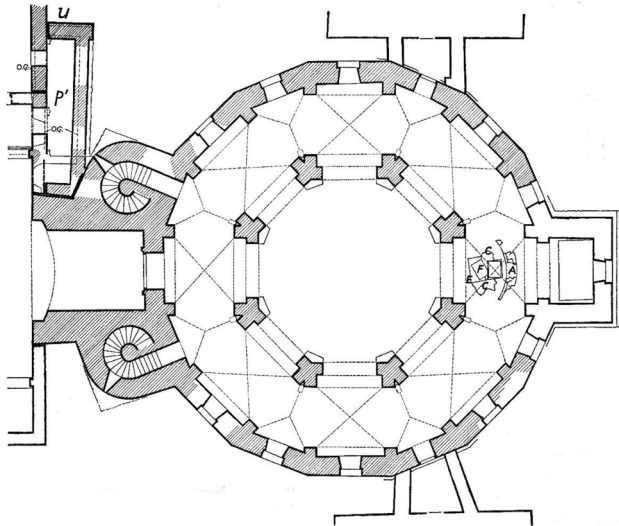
Aachen, Marienkirche, Grundriss, Rekonstruktion
